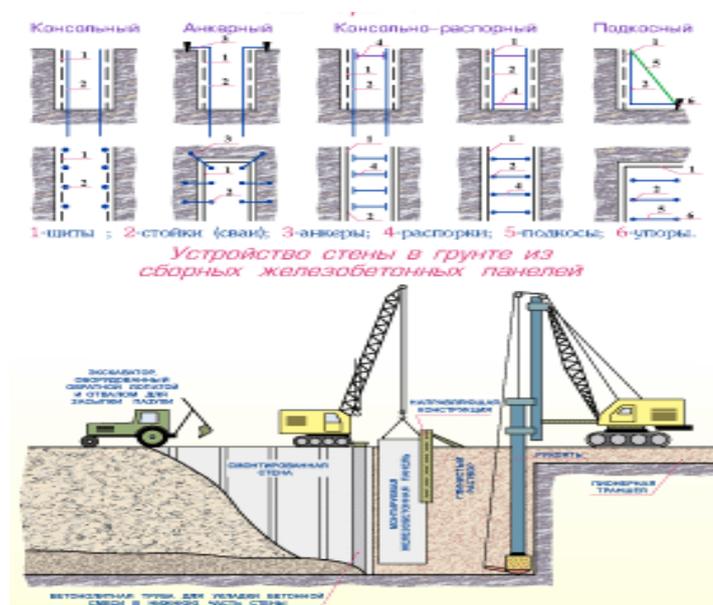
Схемы креплений. Устройство стены в грунте из сборных железобетонных панелей
